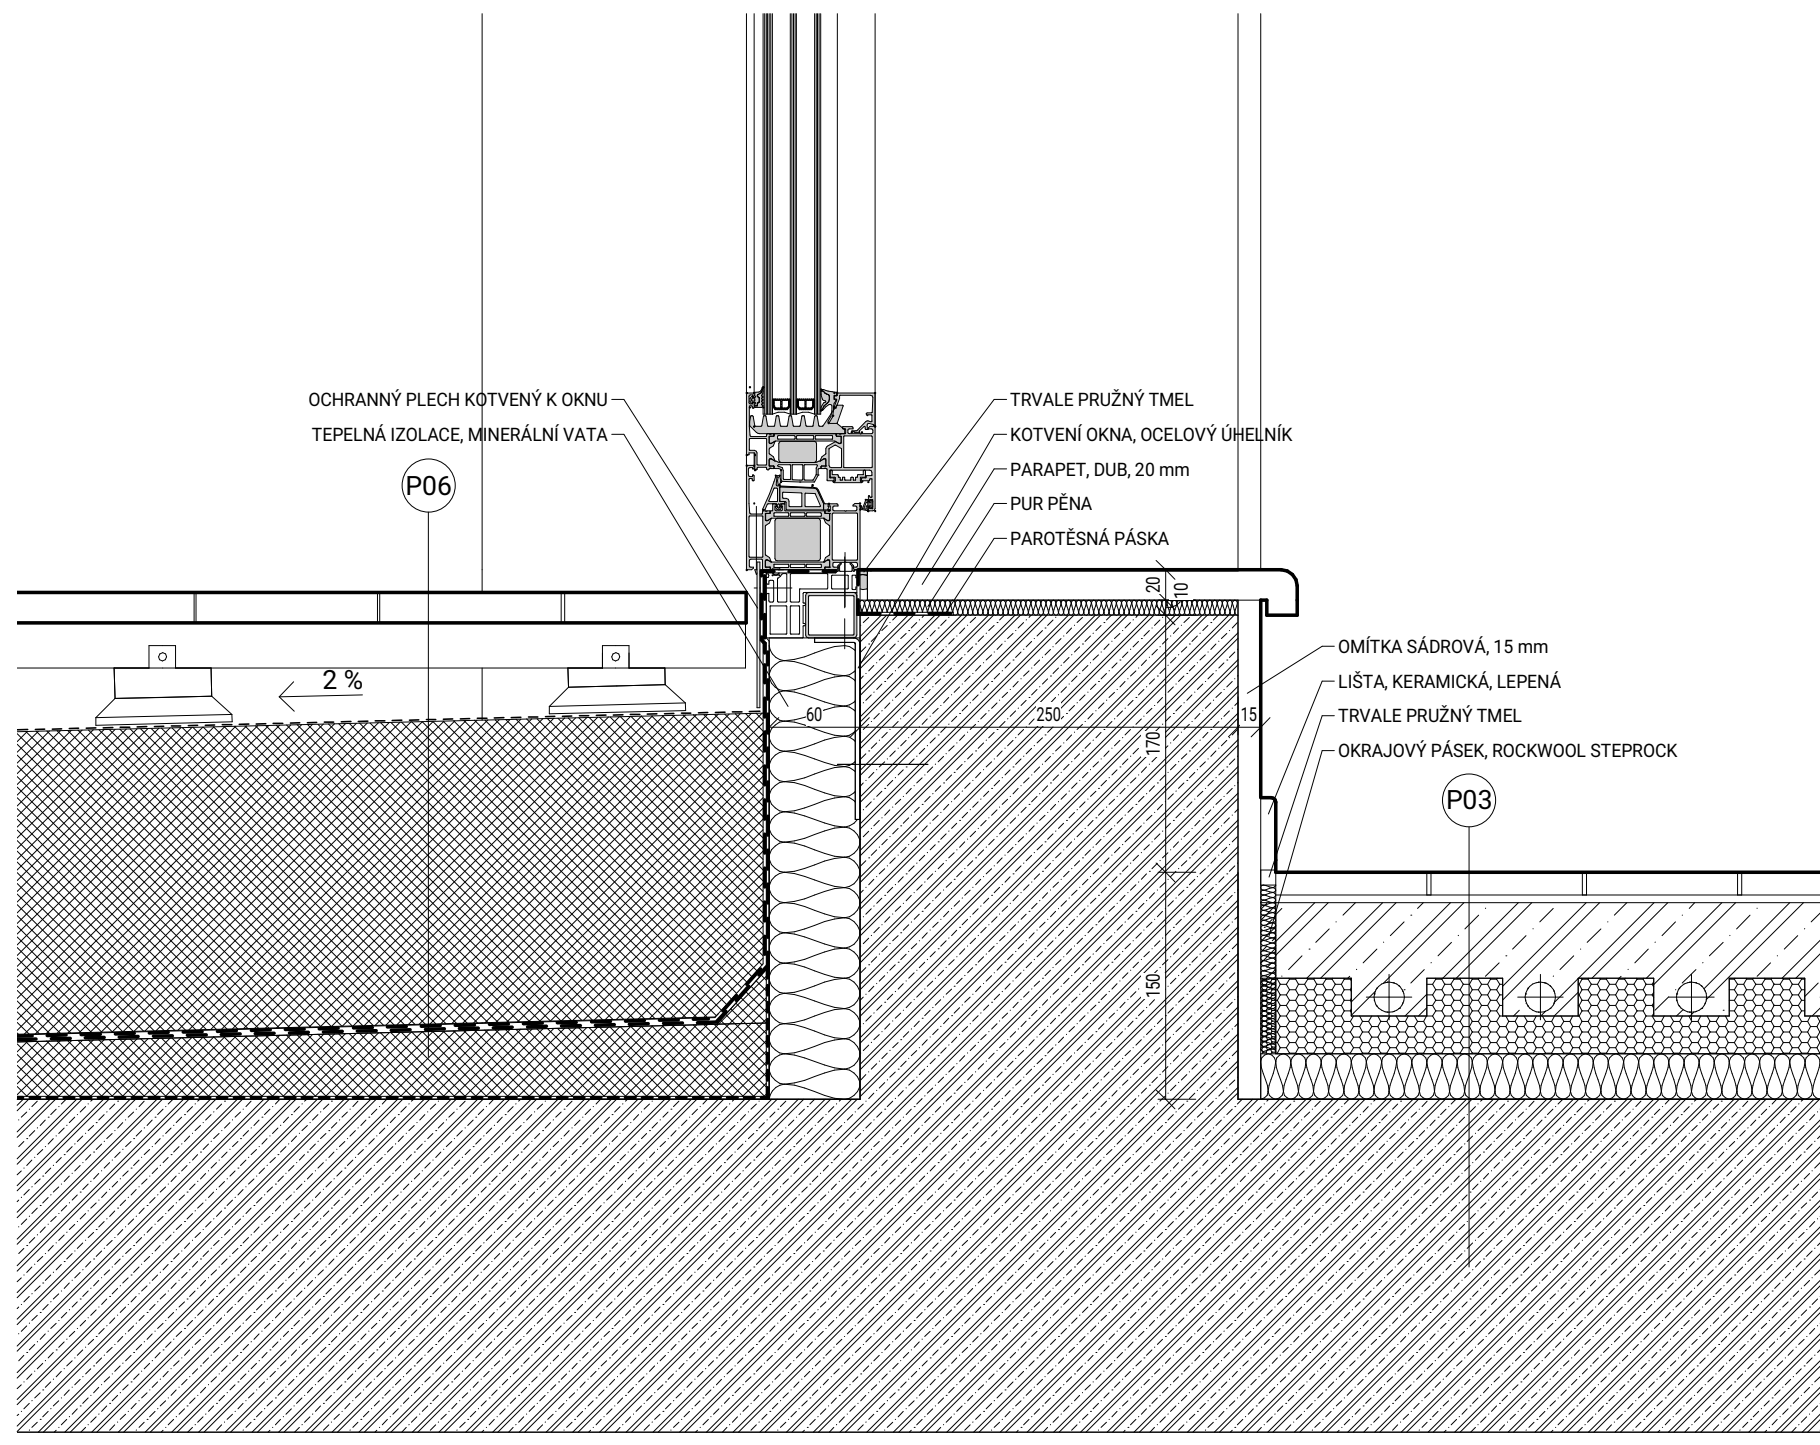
DETAIL PRAHU EXTERIÉROVÝCH DVEŘÍ
